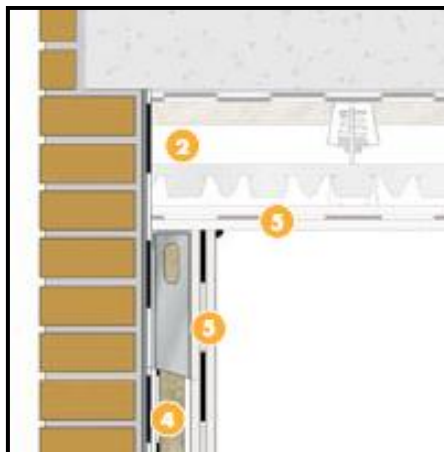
Encuentro pared-techo. (2) Primera capa de aislamiento SONODAN PLUS. (4) Segunda capa de aislamiento SONODAN PLUS. (5) Sándwich acústico: 2 placas de yeso laminar N13 + Membrana Acústica Danosa M.A.D. 4.
